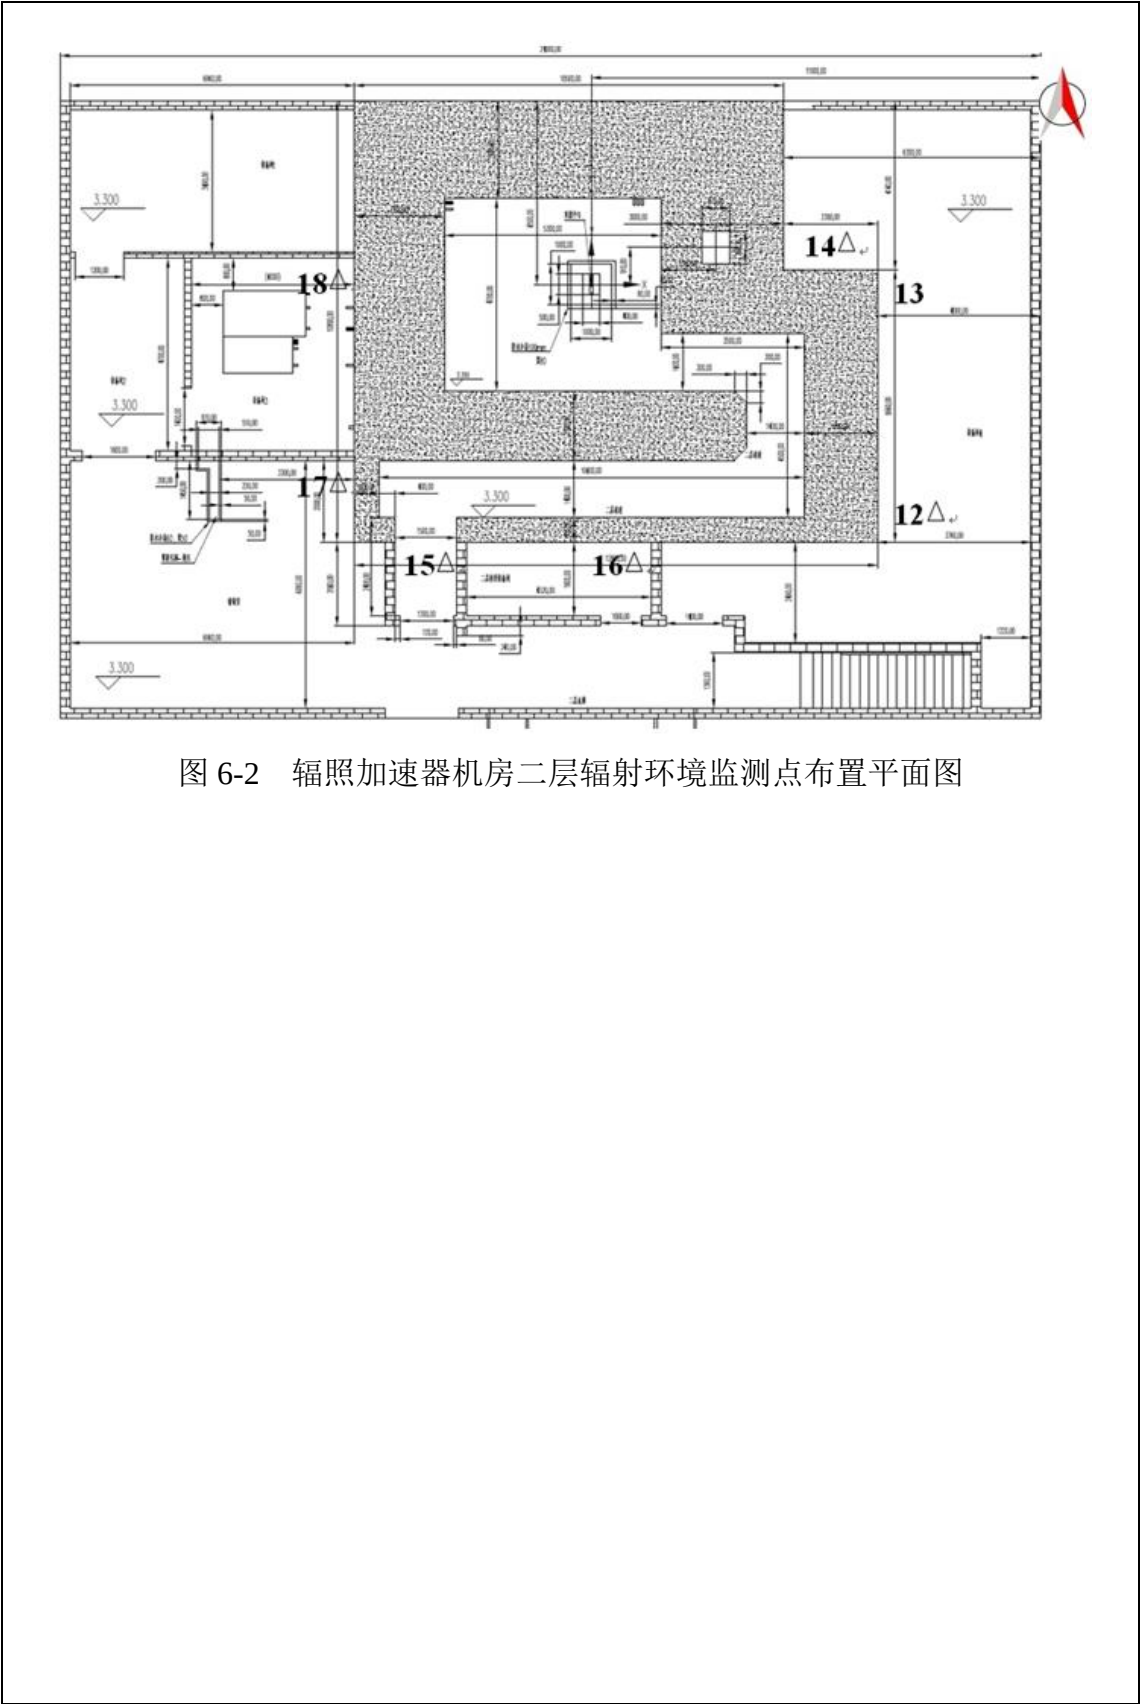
辐照加速器机房二层辐射环境监测点布置平面图
